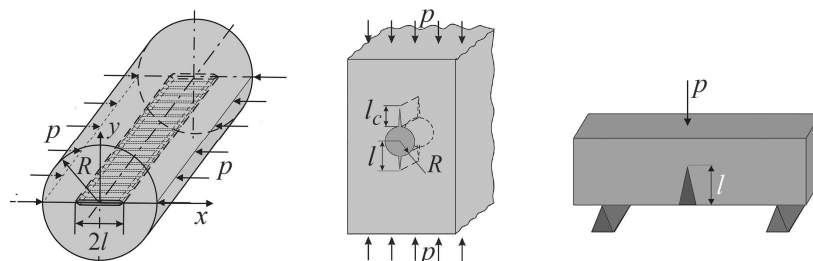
Схеми навантаження бетонних зразків із залікованими дефектами.
